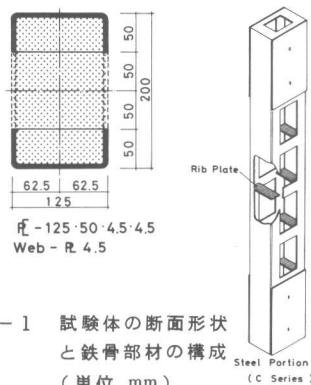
試験体の断面形状と鉄骨部材の構成 (単位, mm)
